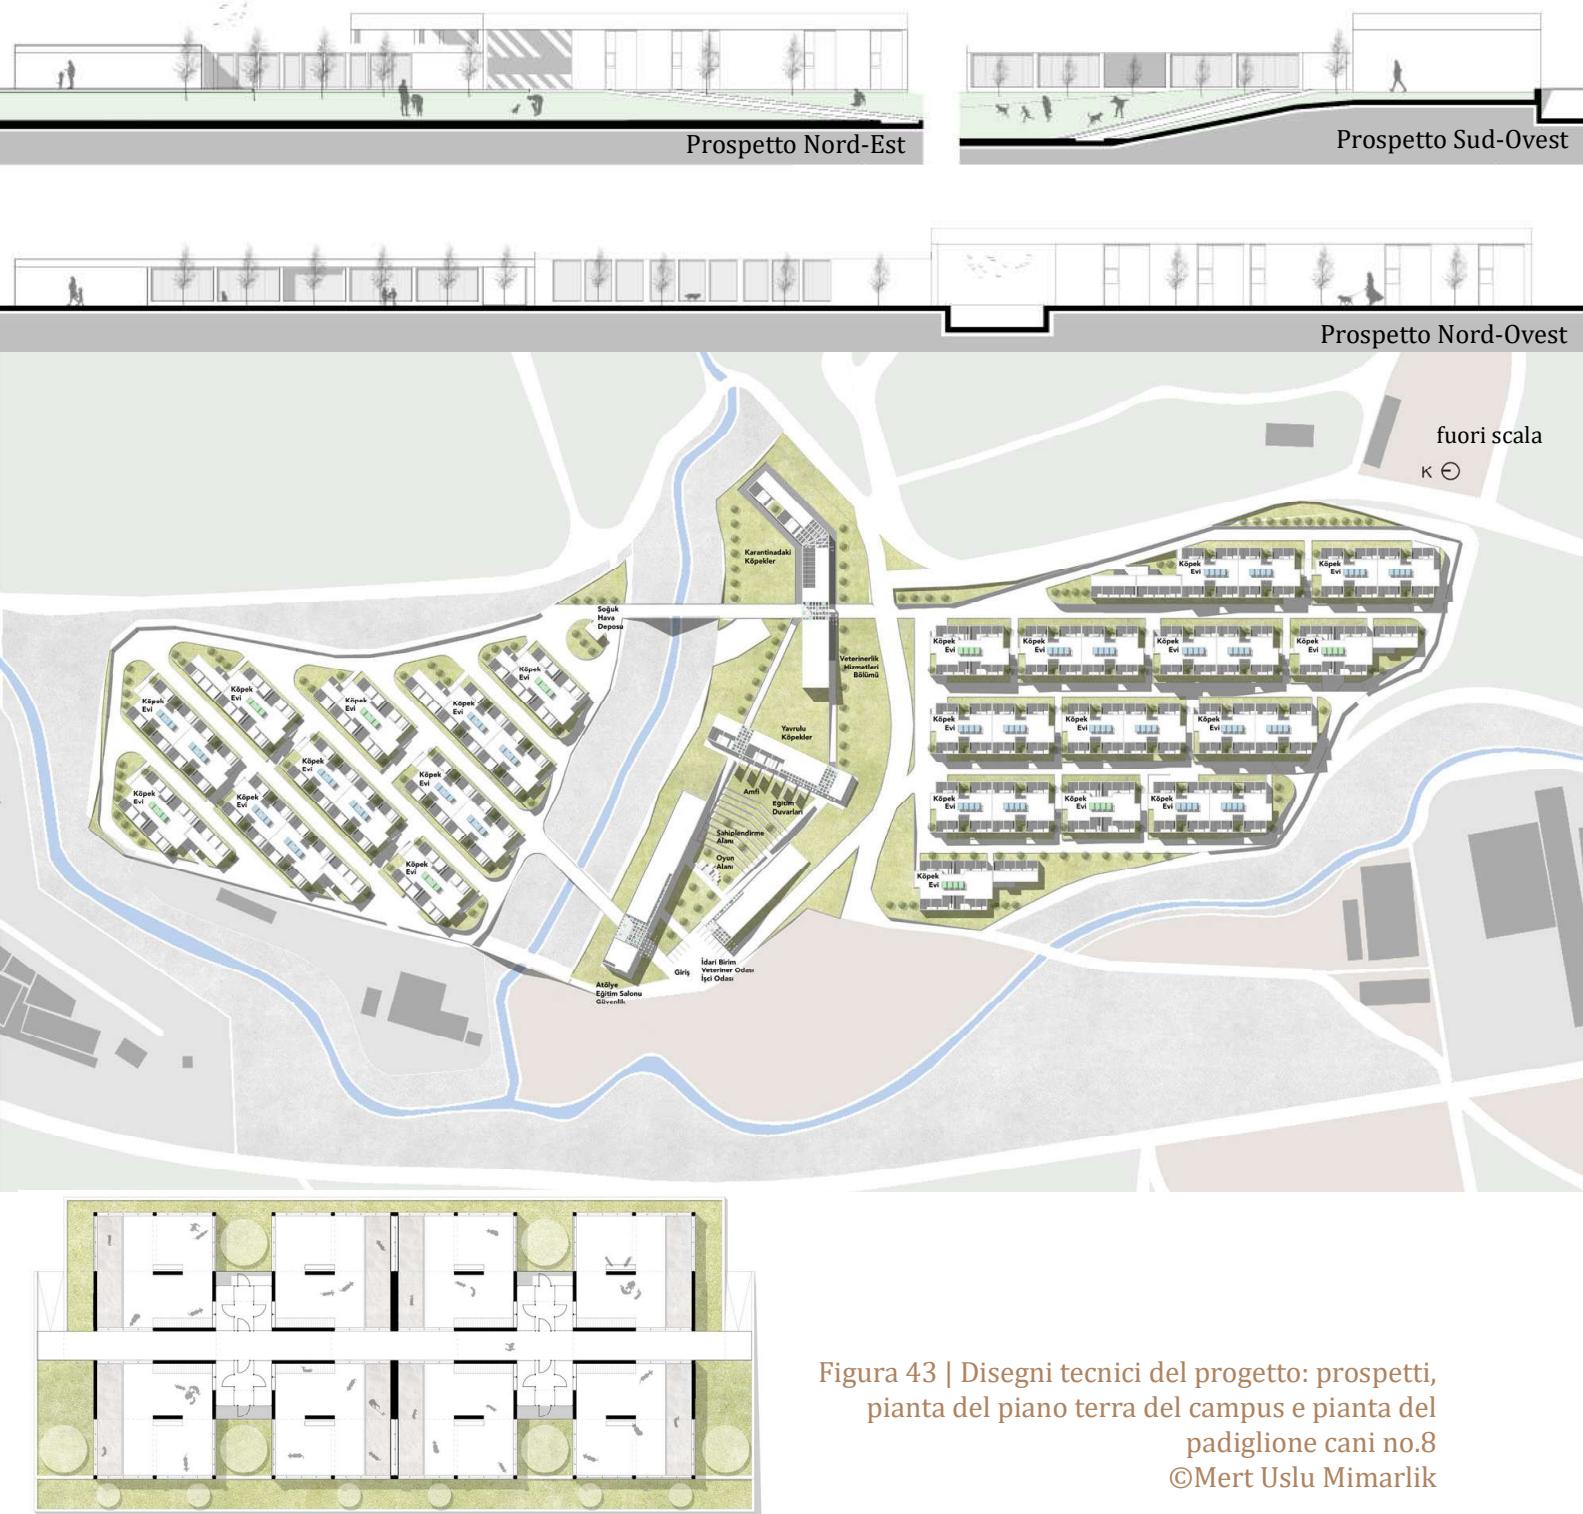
| Disegni tecnici del progetto: prospetti, pianta del piano terra del campus e pianta del padiglione cani no.8
